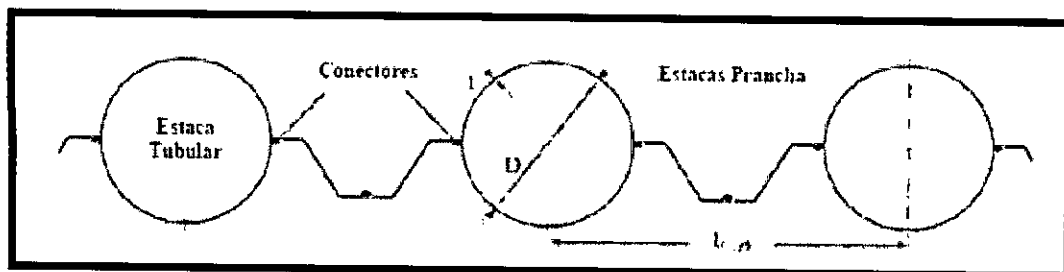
Esquemático Típico da Construção do Barramento Metálico
